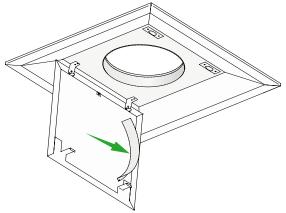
Alternative 1, montage d'une plaque aveugle dans la façade du diffuseur.
